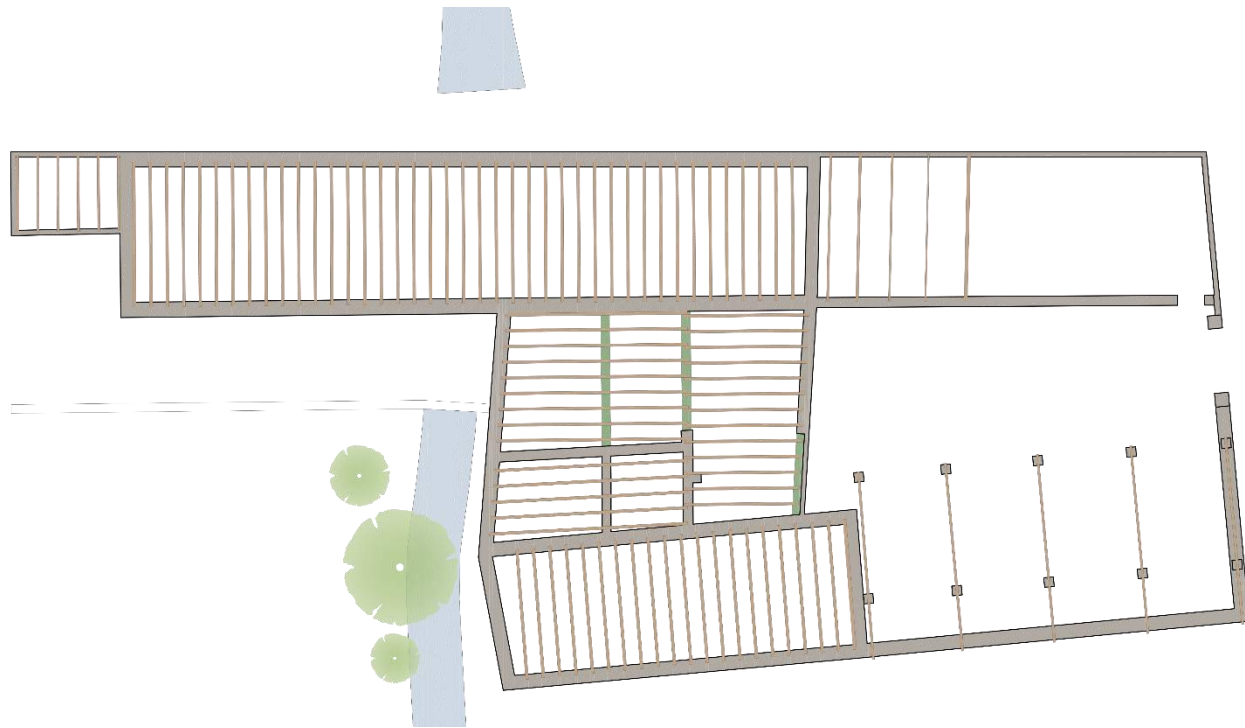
Esquema estructural de vigas y viguetas de cubierta. Autor Propio. 2015.
